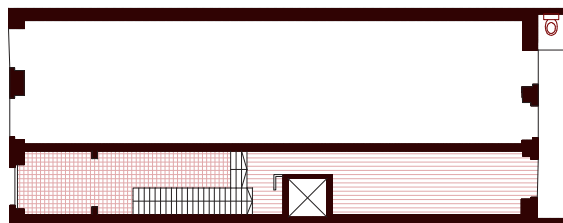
Planta tipo comércio Quarteirão das Cardosas
